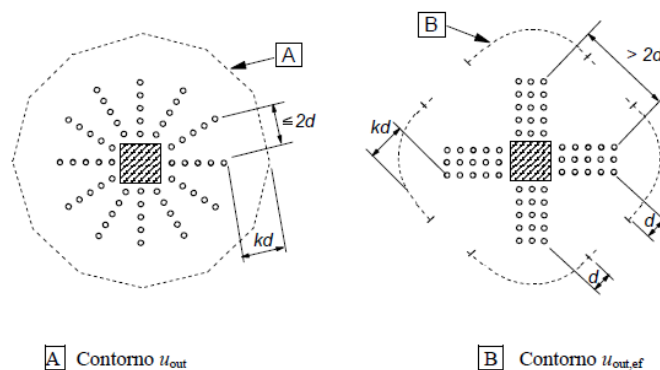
Disposição da armadura e perímetros de controlo para pilares interiores. [10]
